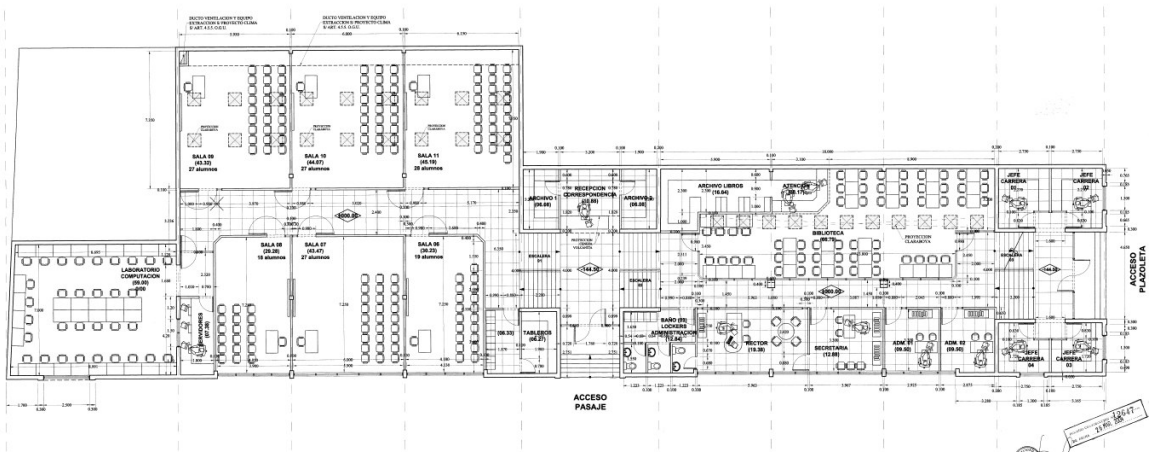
Planta arquitectónica del Segundo piso: 733 m²
